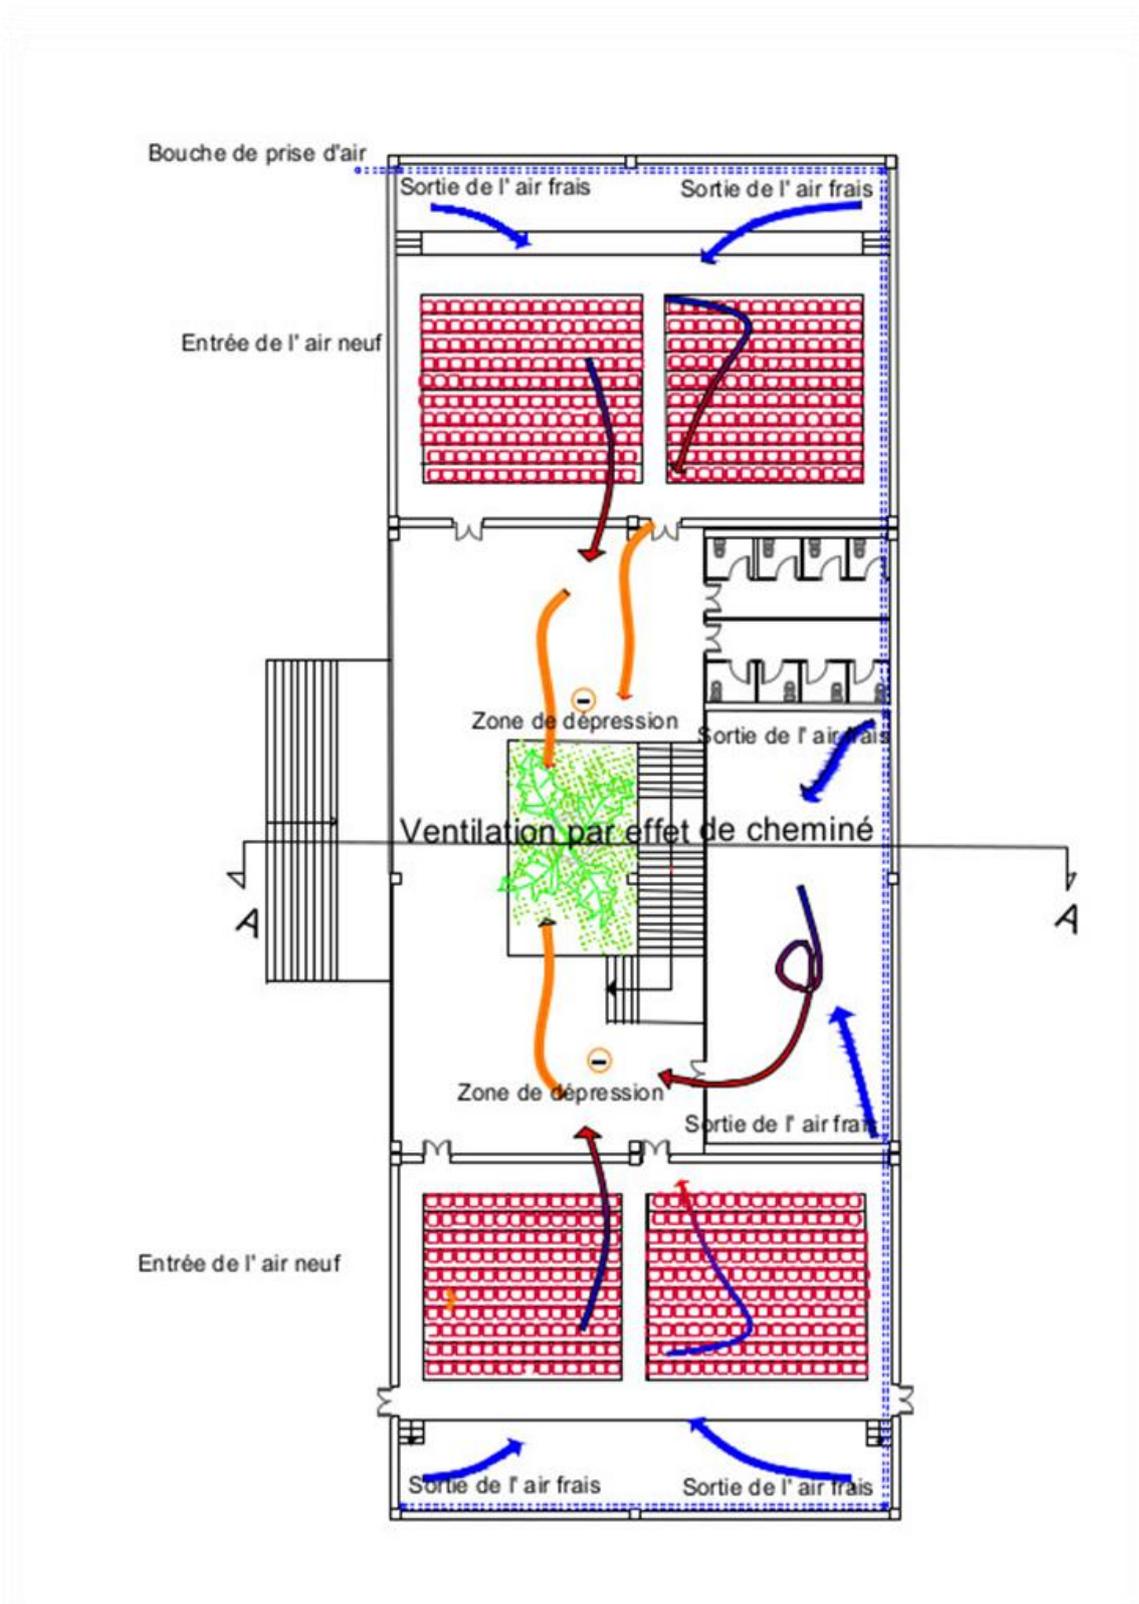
PLAN schématique du rafraîchissement par puits provençal .Source : Auteurs
